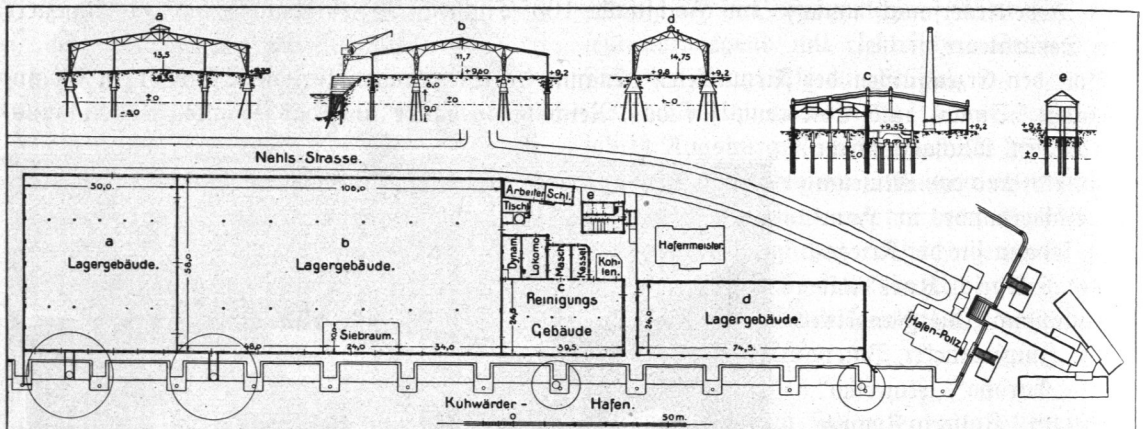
bis 956. Hamburger Reiserwerke m. b. H., Lageplan und Querschnitte.
